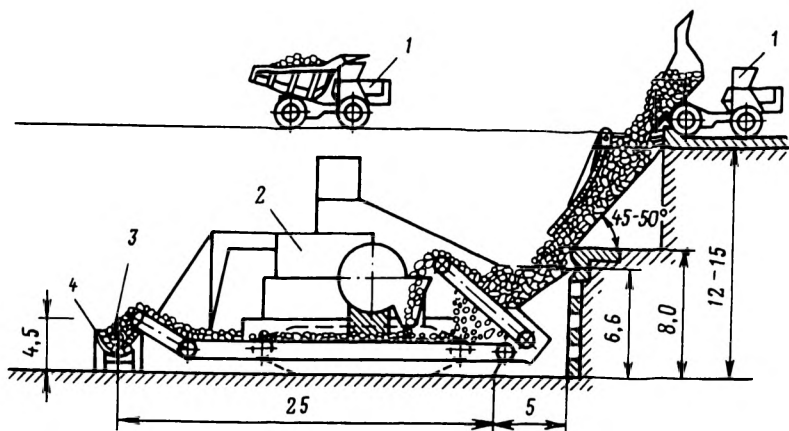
Схема мобильного дробильно-перегрузочного пункта в карьере: 1 — автосамосвал; 2 — самоходный дробильный агрегат СДА-3; 3 — перегрузочная воронка; 4 — забойный конвейер
